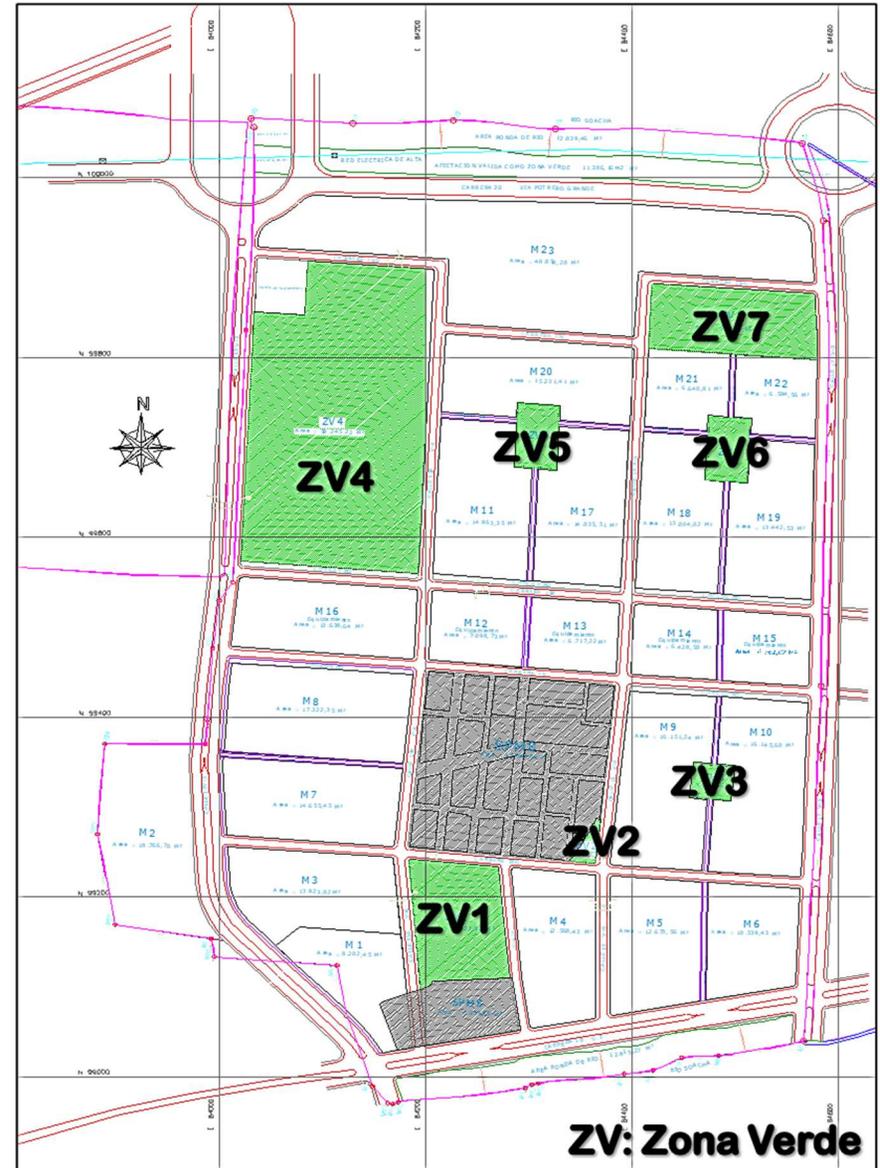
Planteamiento urbanístico U-01 Plancha Plan Parcial Las Vegas. Planimetría aportada por Alcaldía de Soacha CU-001 2014.
